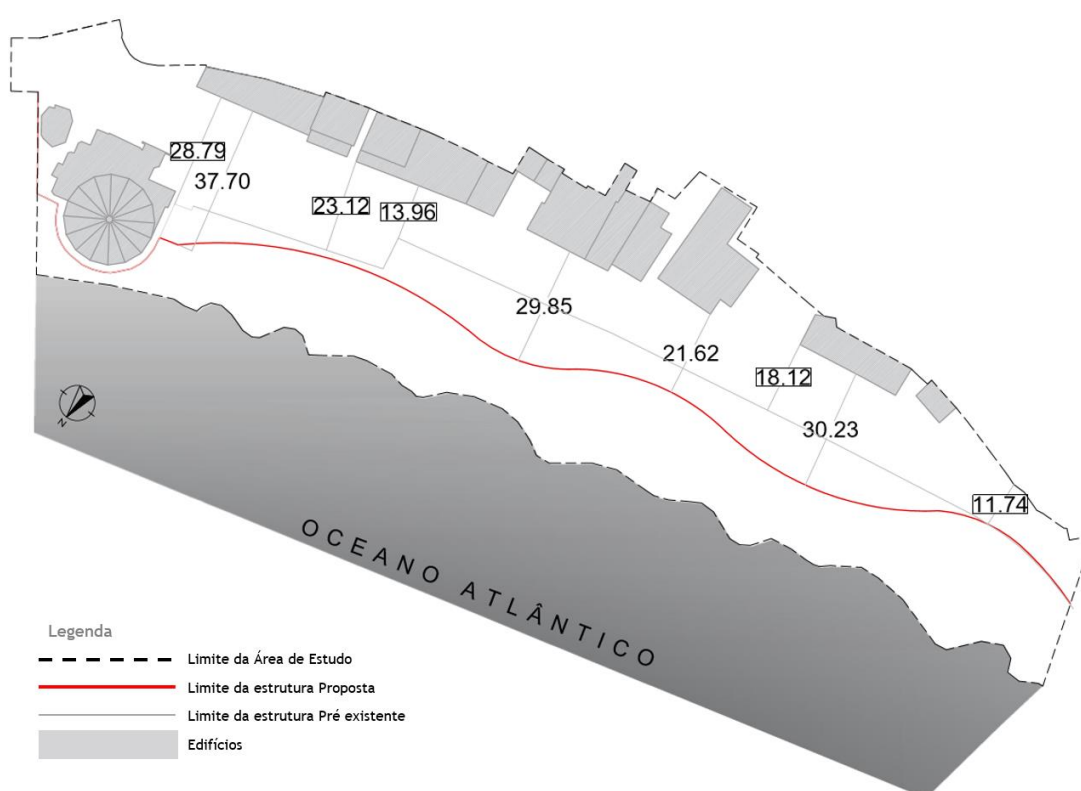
Planta esquemática: Zona do Calhau. Infraestrutura. [s/escala]
